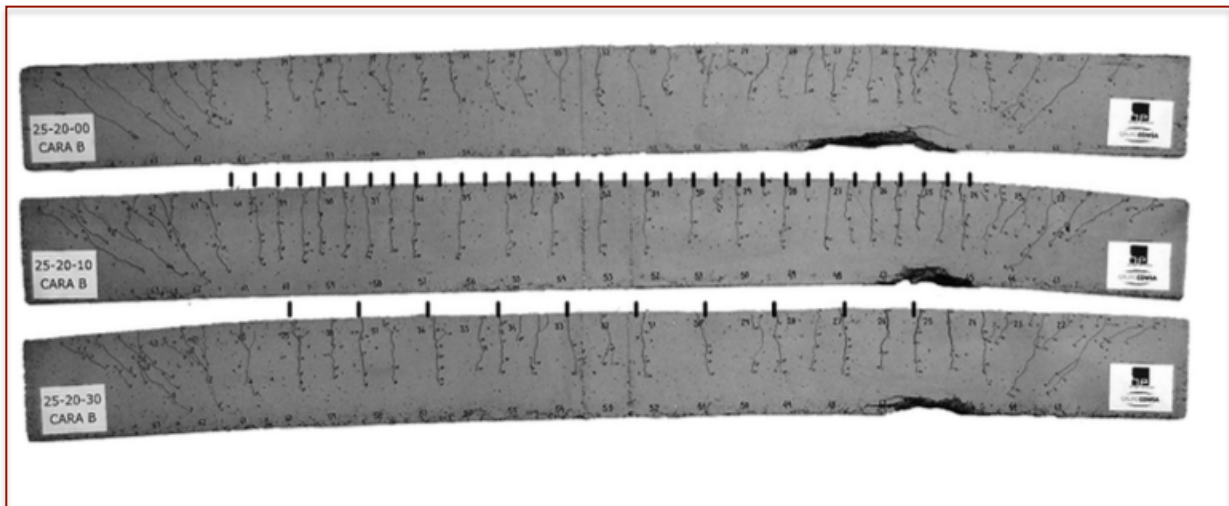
Efeito do espaçamento entre estribos no espaçamento de fendas, em vigas de diâmetros de 25 cm de armadura longitudinal ($c=20$ mm) [7].
